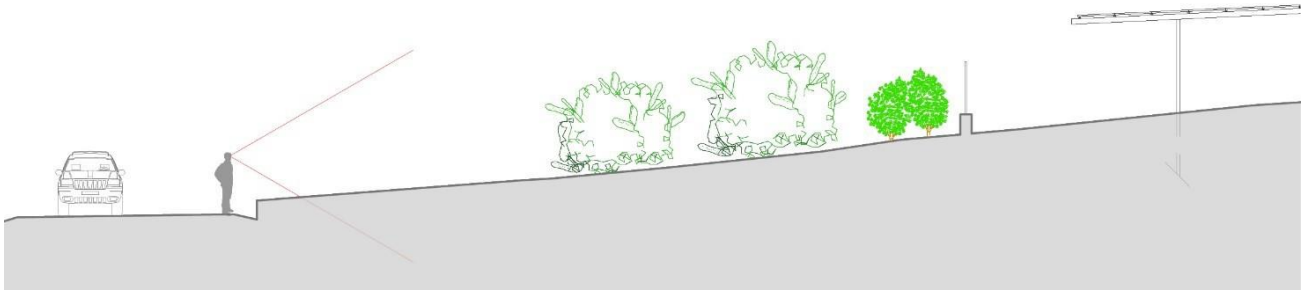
Sezione stradale -Mitigazione ambientale perimetrale.
